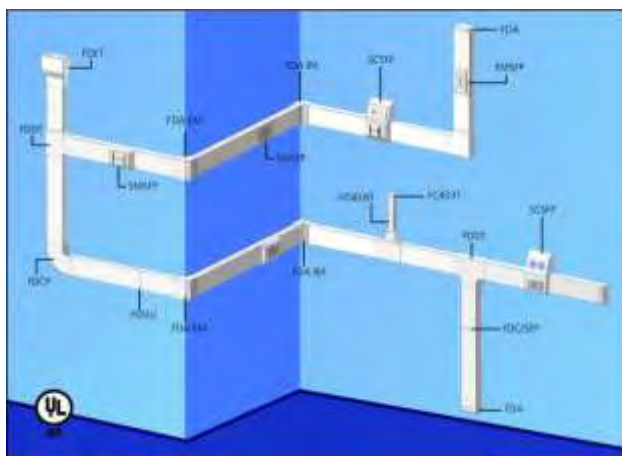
Sistema desarrollado para atender a las Normas de Cableado Estructurado.
